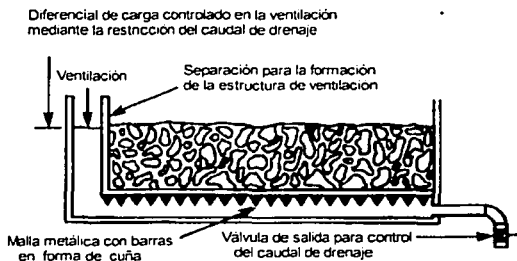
Sección transversal de malla metálica de escurrimiento.
